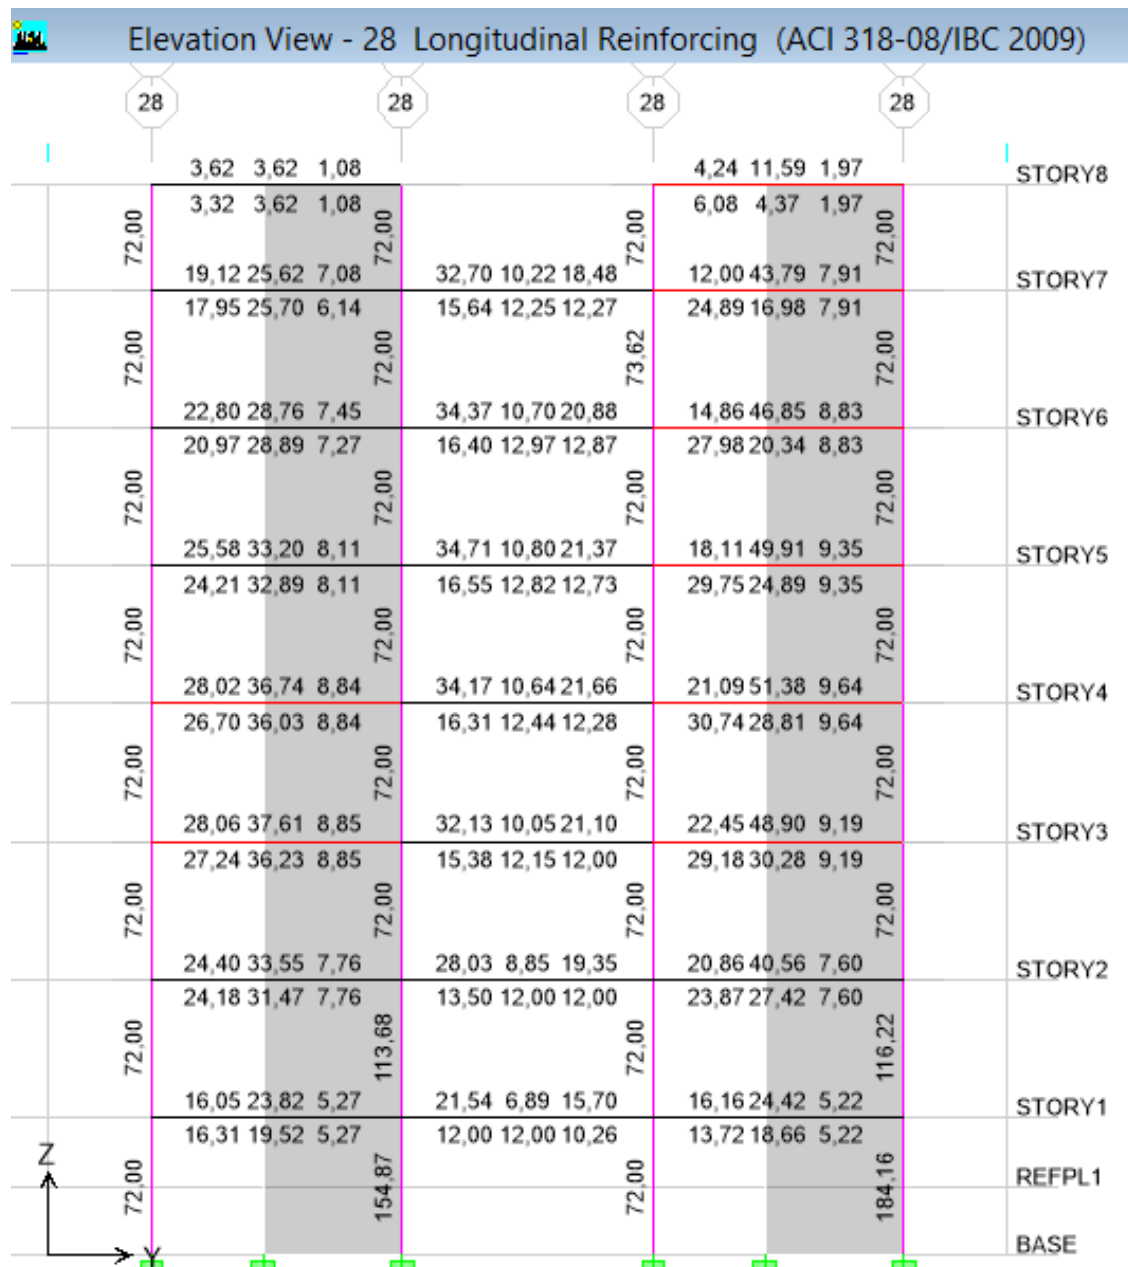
Acero en Vigas y Columnas en el Pórtico 28 – Hospitalización 2- (CEC-2002)
